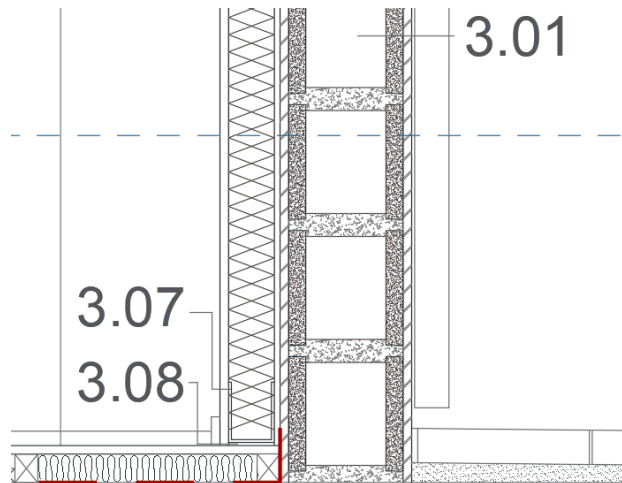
detalle de aislamiento acústico en pared y piso. Elaboración propia
